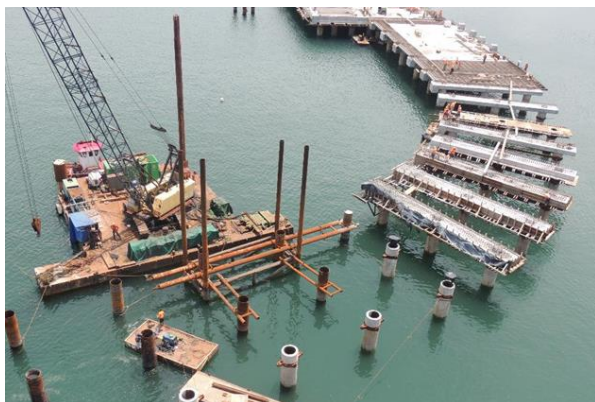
Vista del Muelle Granelero de Caldera en construcción.
